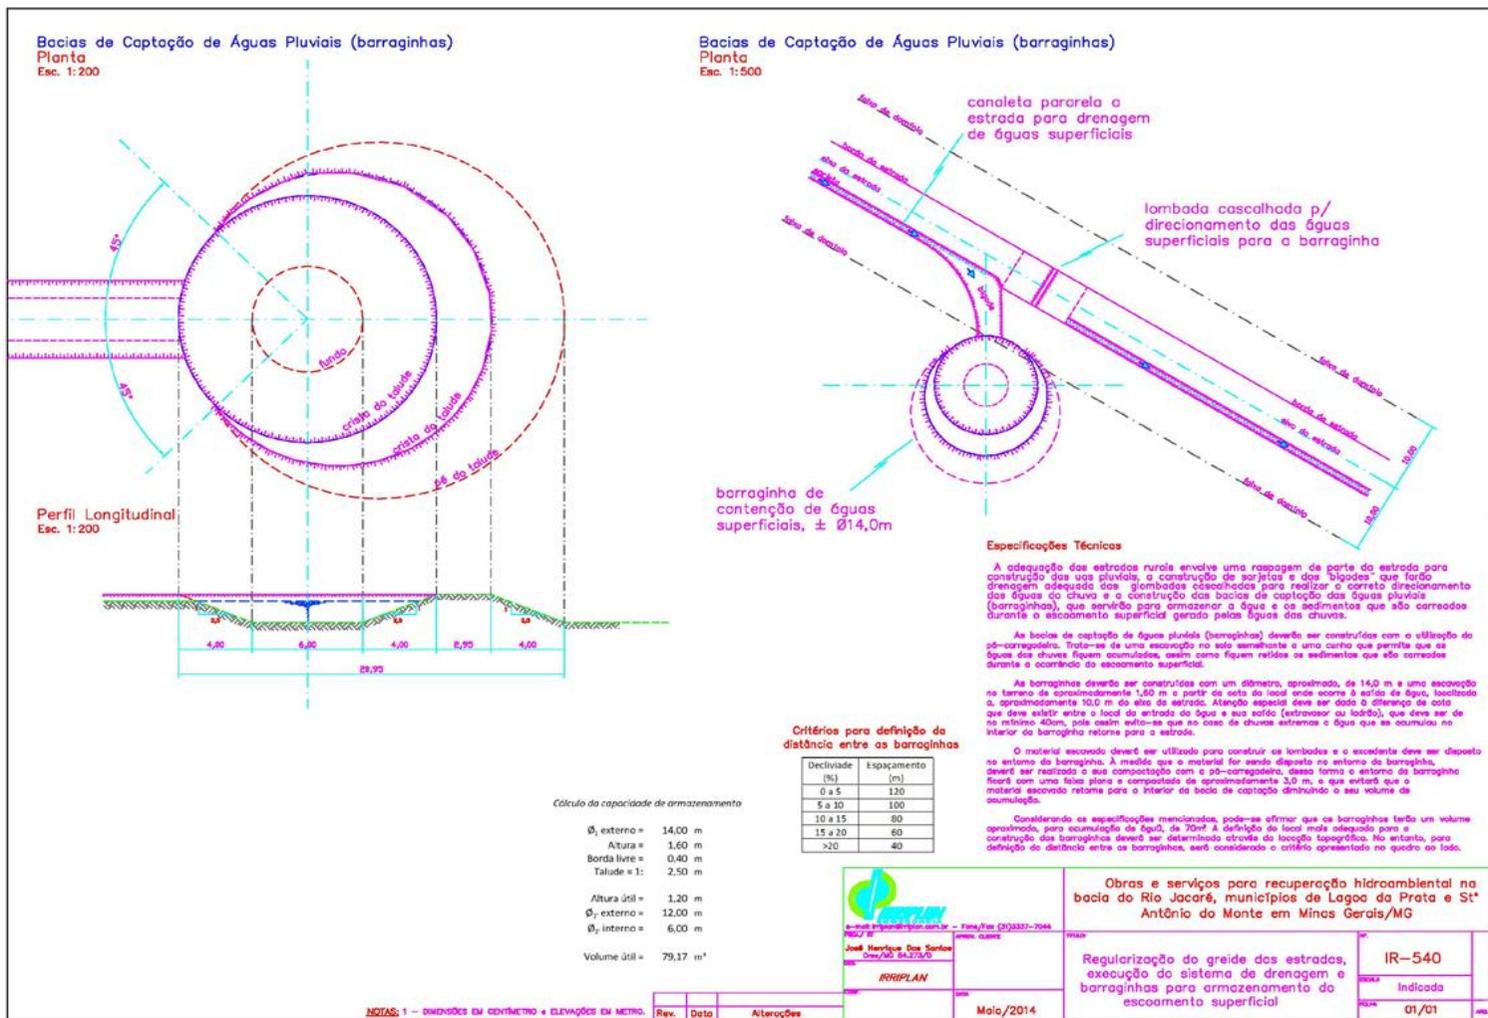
Layout com especificações técnicas para a construção de bacias de captação para drenagem de estradas rurais
